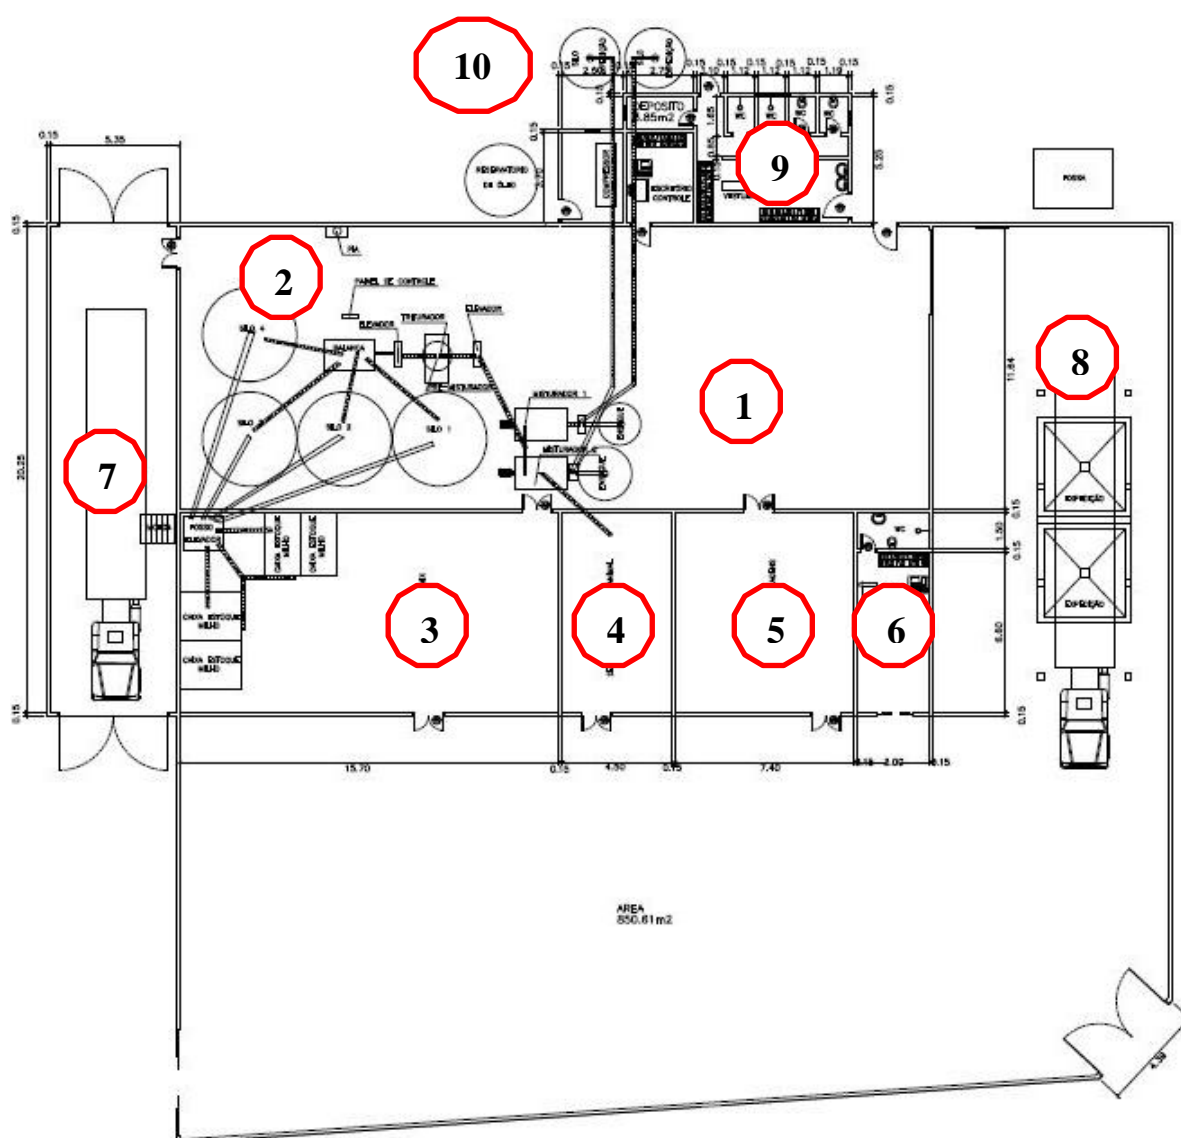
Planta baixa da Agronorte Nutrição Animal LTDA.
